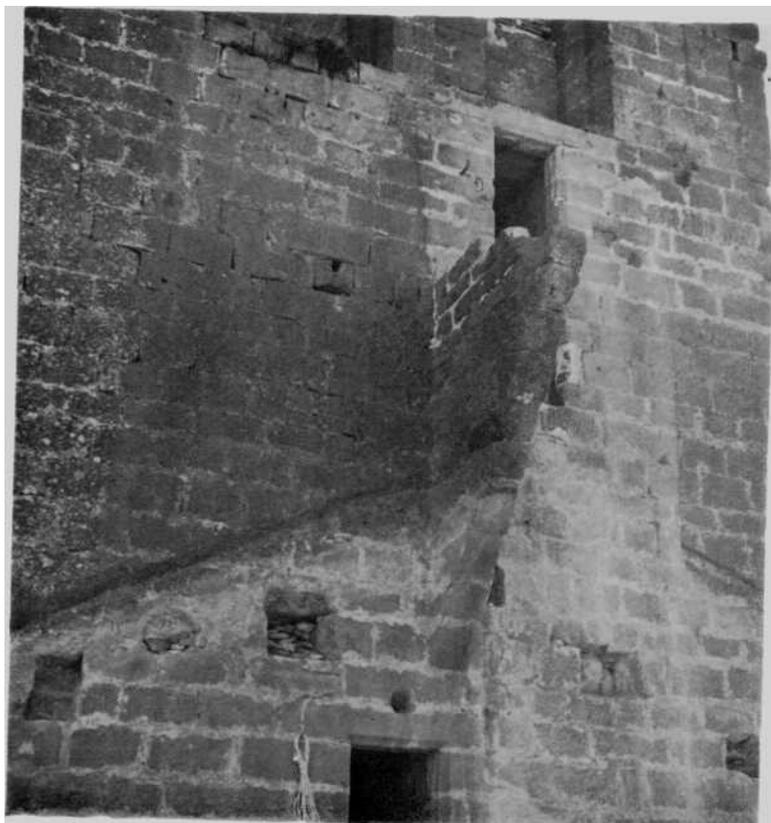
Voladizo de apoyo del puente levadizo y puertas de acceso a los pisos 3.º y 4.º de la torre.
